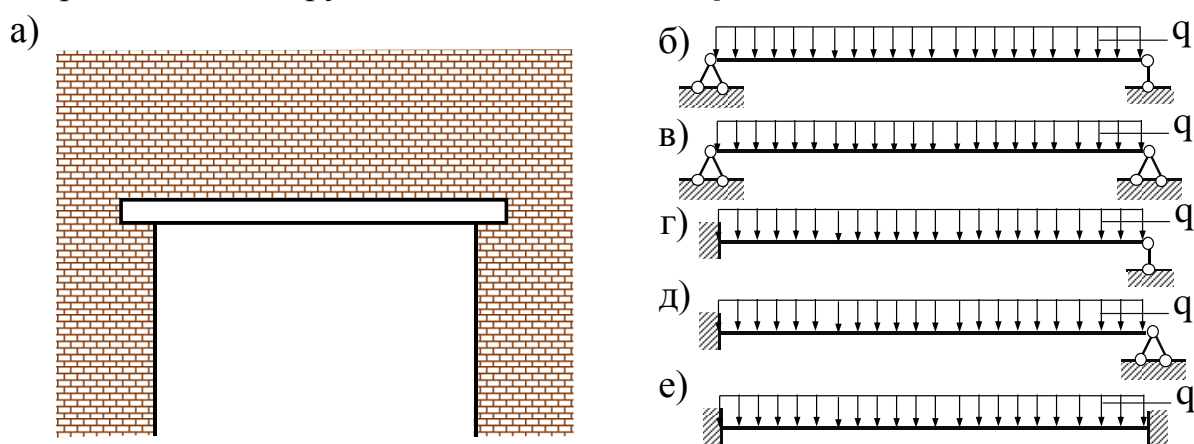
Возможные расчетные схемы железобетонной перемычки.
